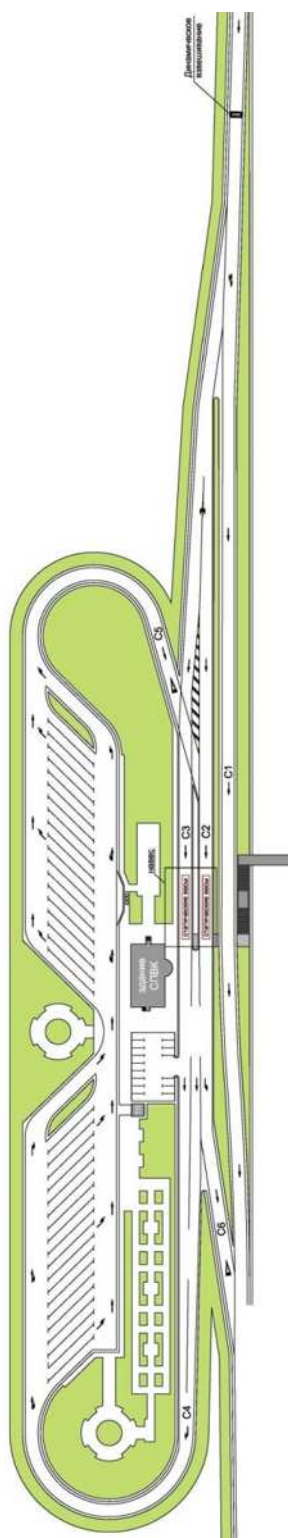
Типовое планировочное решение по СПВК (вариант № 3)
